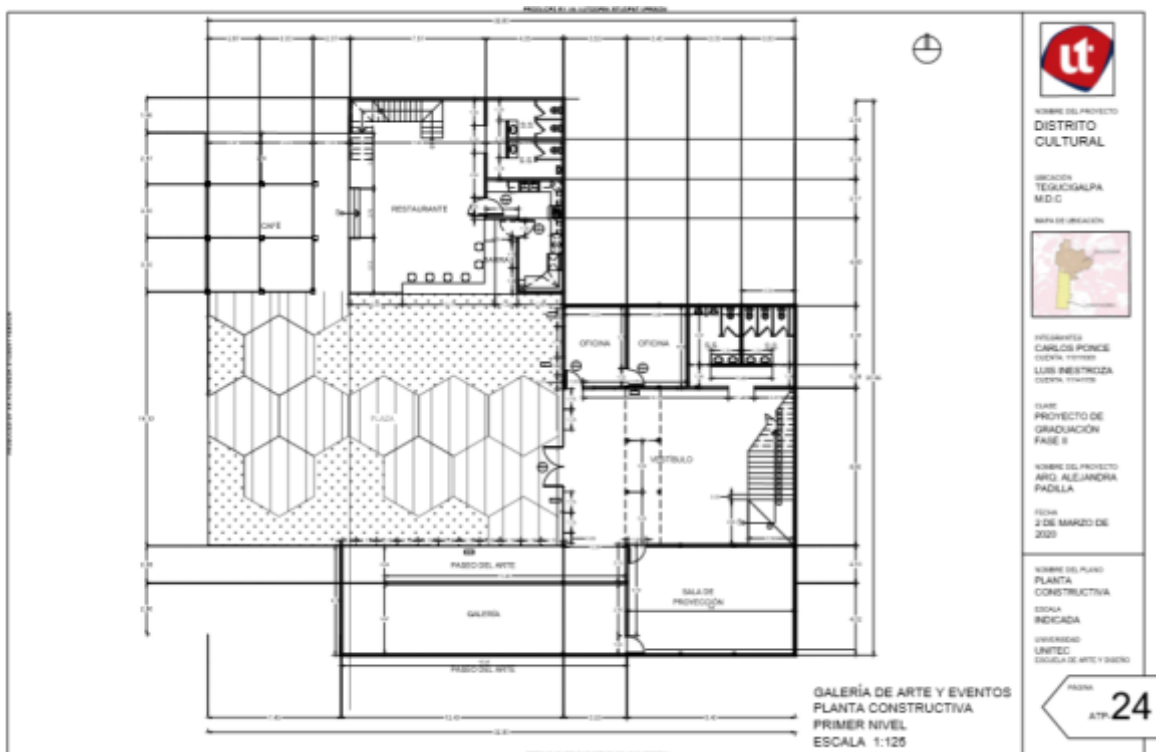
Planta Constructiva Galería de Arte y Eventos Primer Nivel
